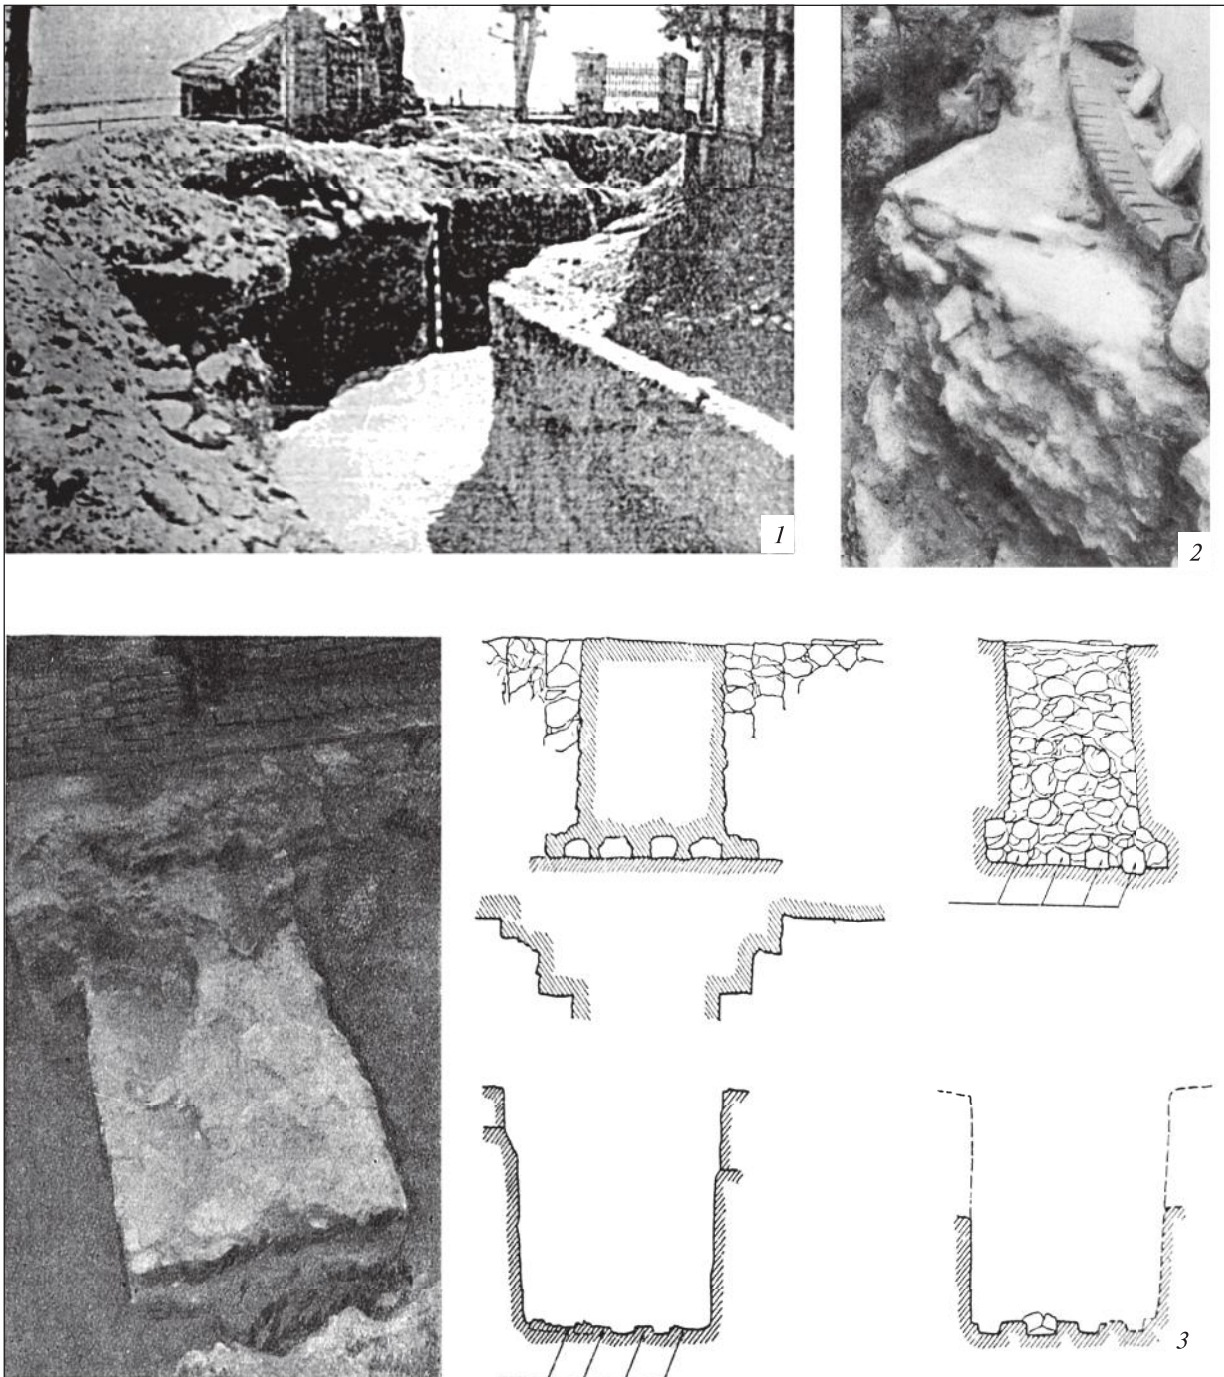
Фото та креслення з розкопок 1952 р.: 1 — фундаментні рови північної апсиди; 2 — фундамент та нижній ряд цегляної кладки північної апсиди; 3 — розрізи фундаментів та фундаментних ровів
